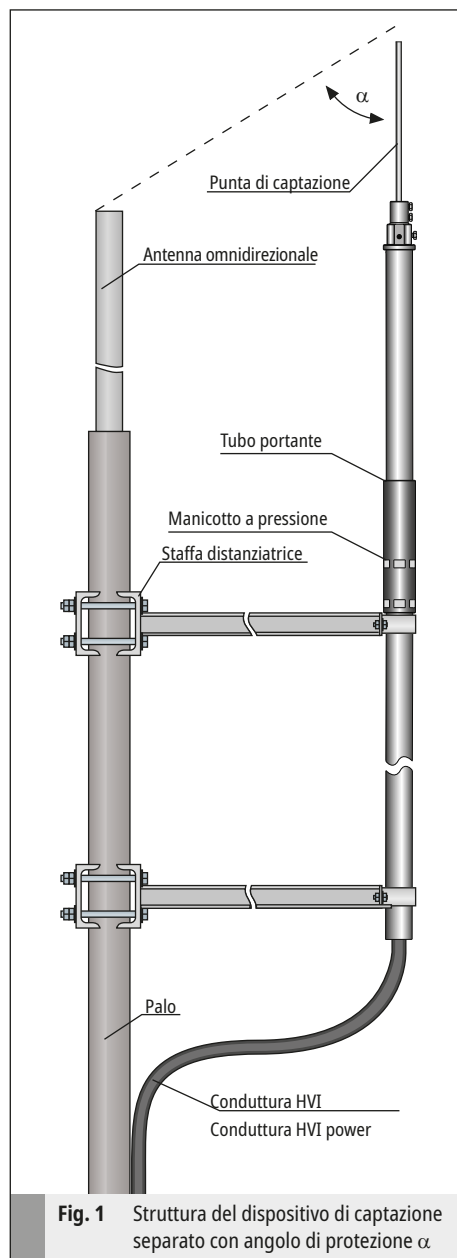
Struttura del dispositivo di captazione separato con angolo di protezione α
